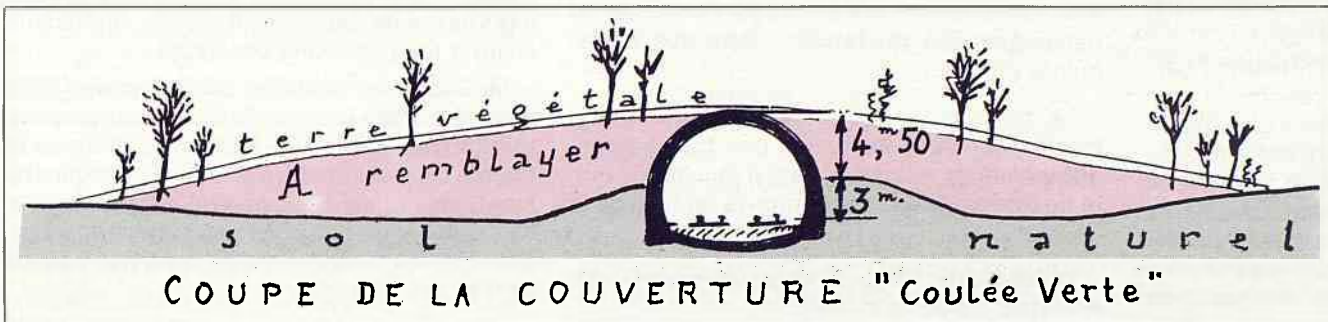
l'excroissance du tunnel doit être cachée par une masse de terre bien plantée.
